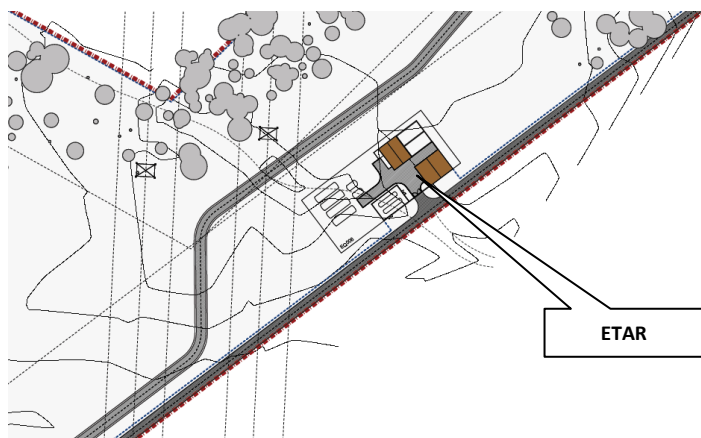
Recinto da ETAR (pormenor da planta de projeto, s/escala)
